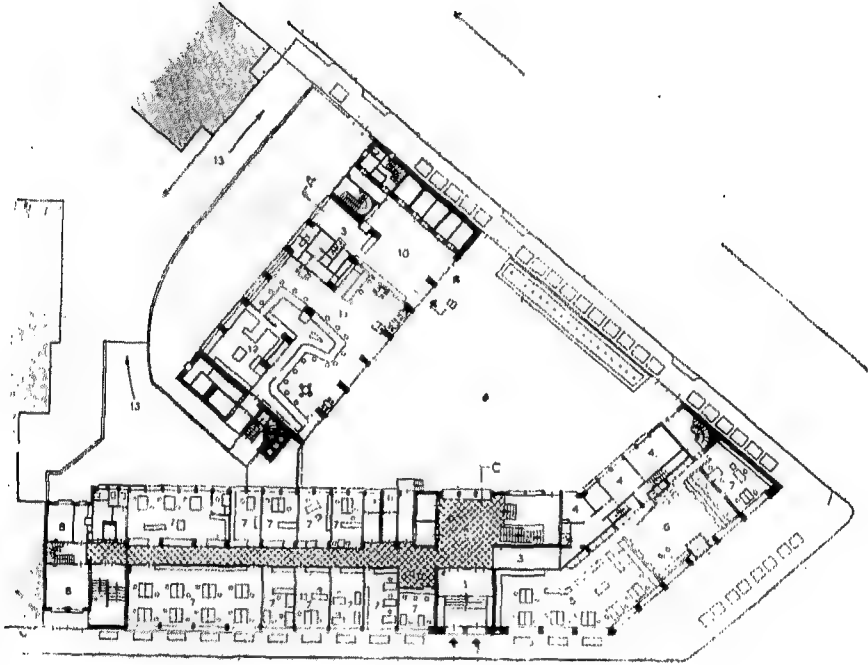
٣٨ - ٦ : مسقط أفقى الدور المتكرر - الزوجى.
